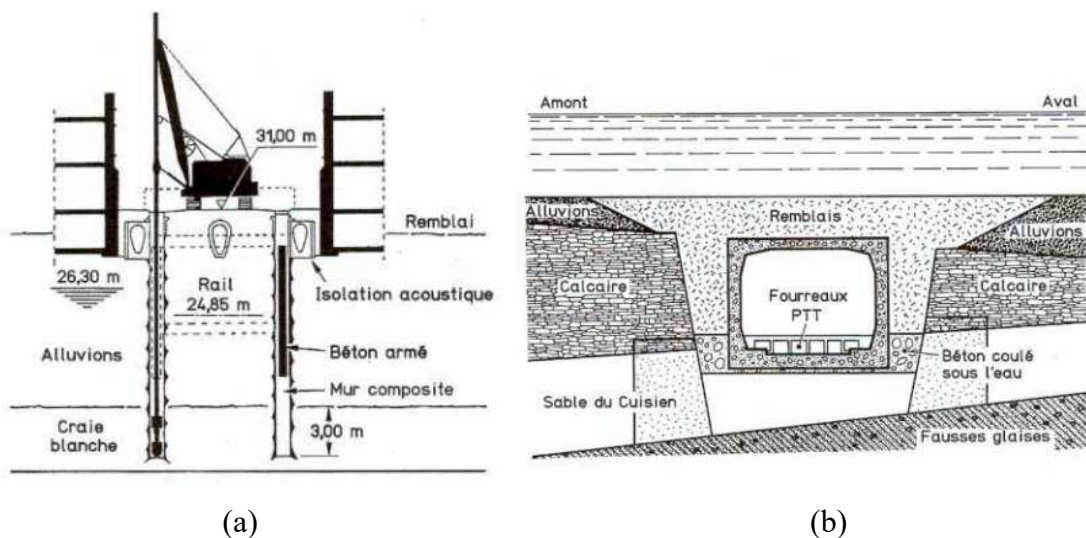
Ouvrages souterrains exécutés en fouille: (a) Tunnel construit à ciel ouvert ; (b) Tunnel immergé.
